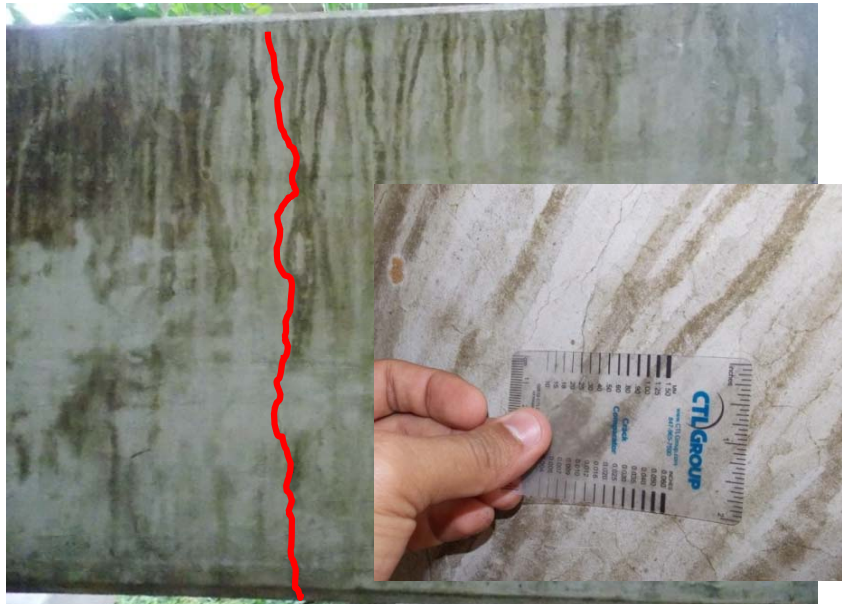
Losa de concreto de la superestructura 2: Agrietamiento transversal con evidencia de eflorescencia.
